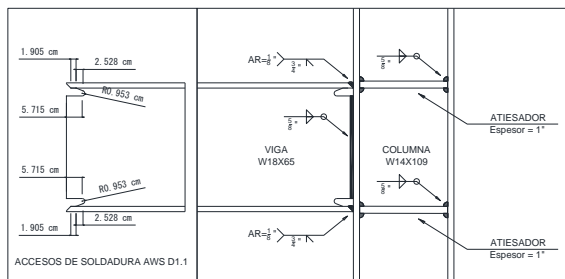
Conexión por medio de soldadura directa para probeta CM-FP\_02.
